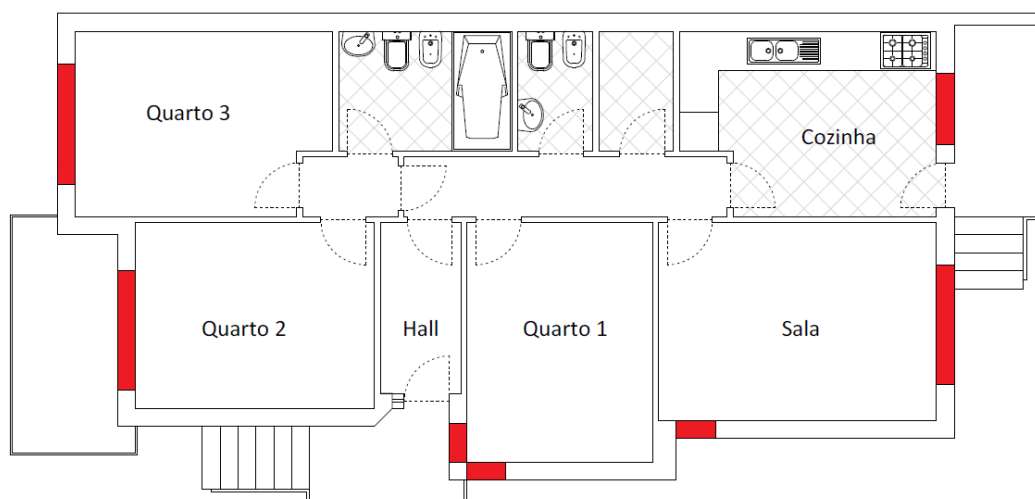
Ligação da fachada com a zona de caixa de estores.
